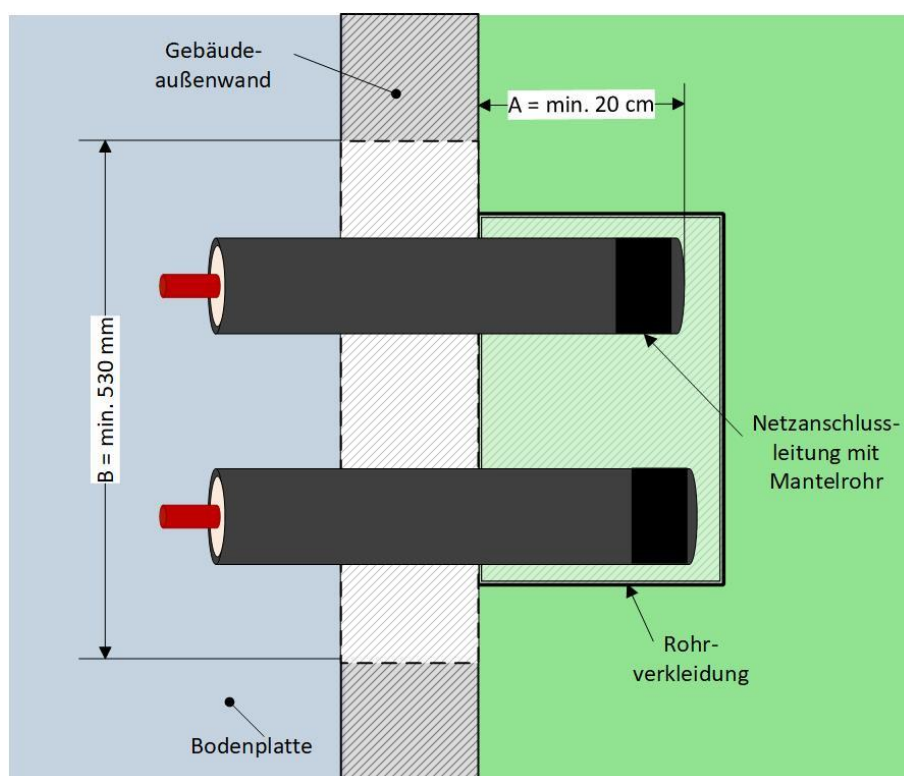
Oberirdische Hauseinführung: Draufsicht
